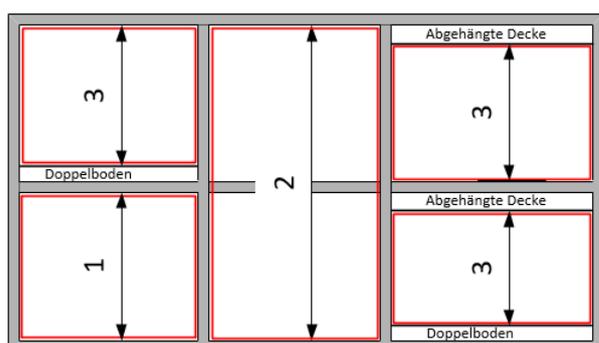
Sezione con rappresentazione dell'altezza libera del locale
